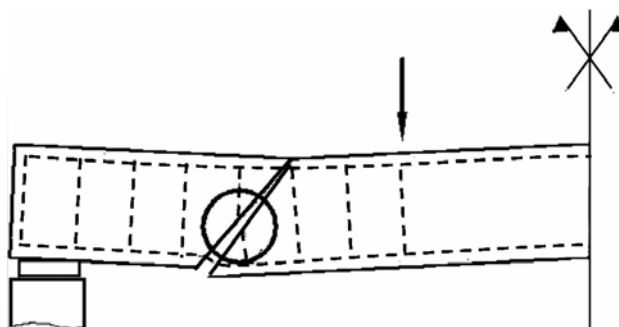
Ruptura da armadura transversal - FONTE: Pinheiro, 2007.
